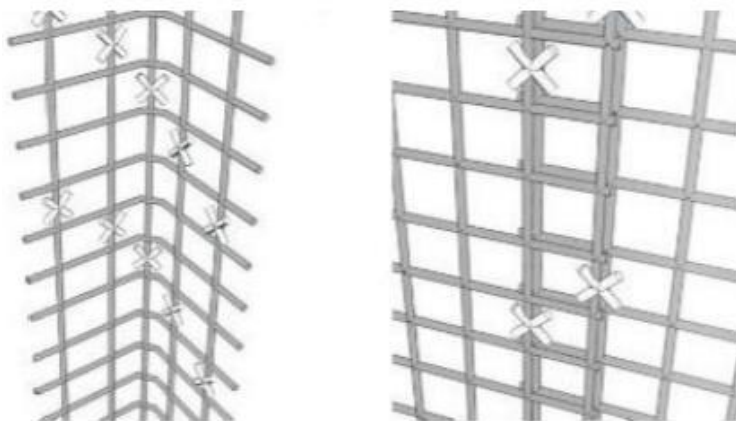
Telas de reforço em cantos e entre painéis (Fonte: Cassaforma)
